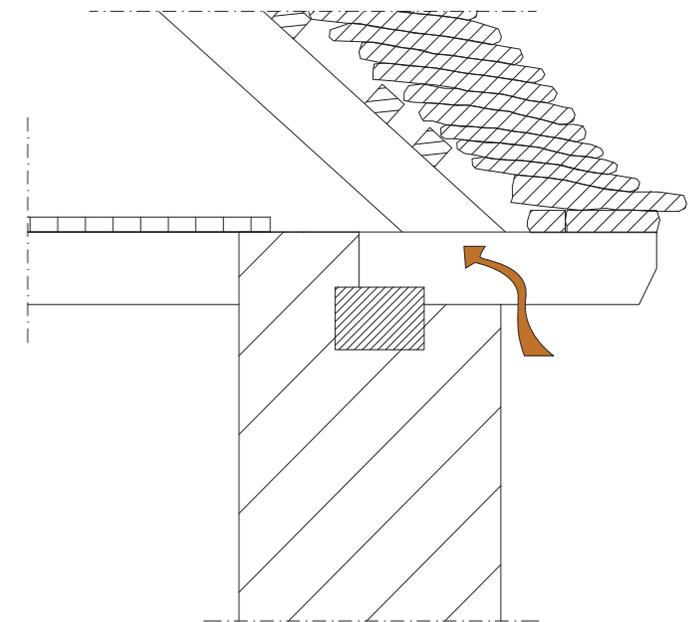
Stralcio schema sezione tetto ossolano. Si può notare l'areazione del tetto.
